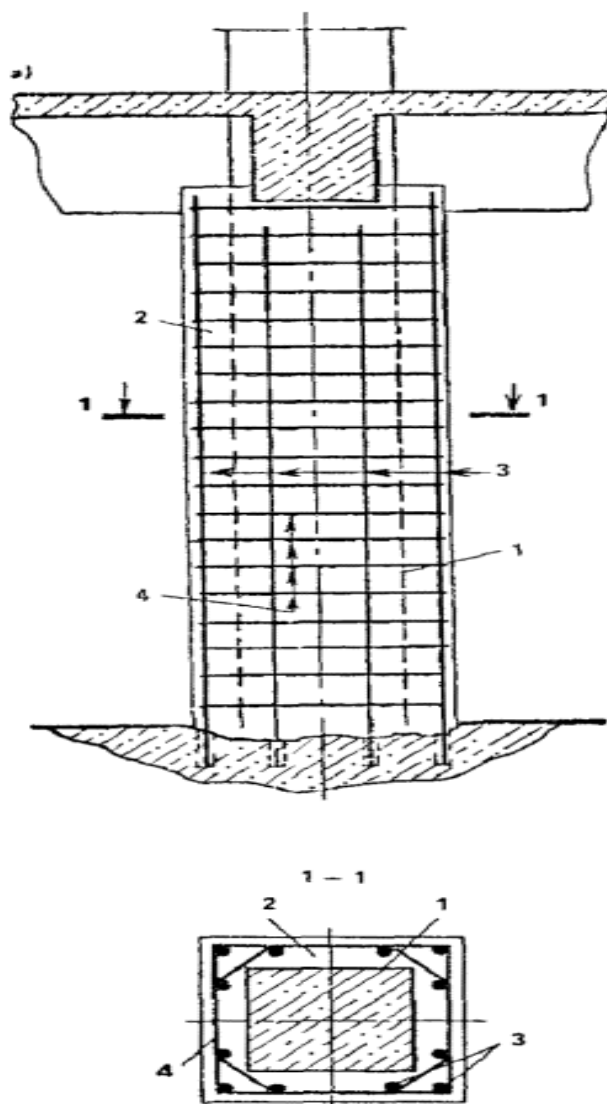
Усиление колонн железобетонной обоймой: *a* - со стержневой арматурой; 1 - усиливаемая колонна; 2 - обойма; 3 - продольная арматура
